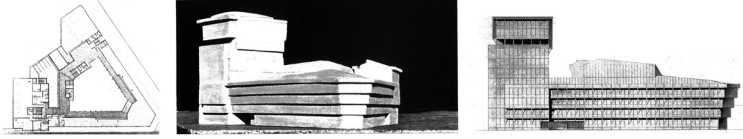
Rafael Moneo. Planta, alzado y maqueta del proyecto para la sede del Banco de Vizcaya en Bilbao, 1964-1965.
